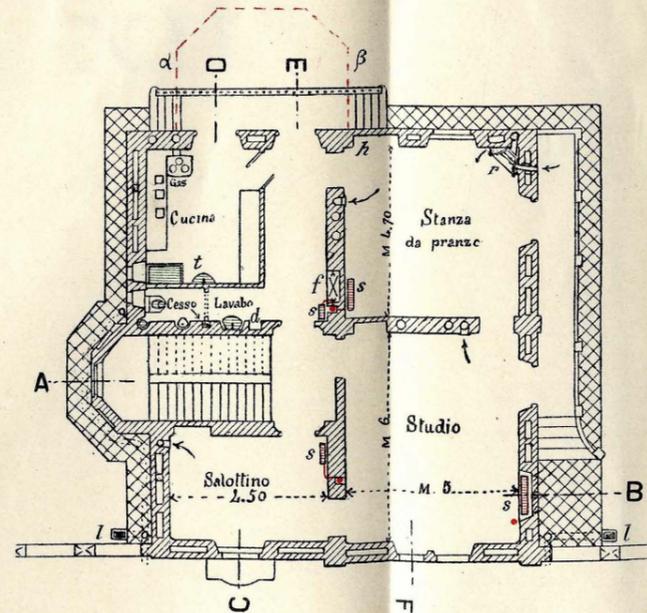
Pianta del piano terreno (Scala 1:200).
